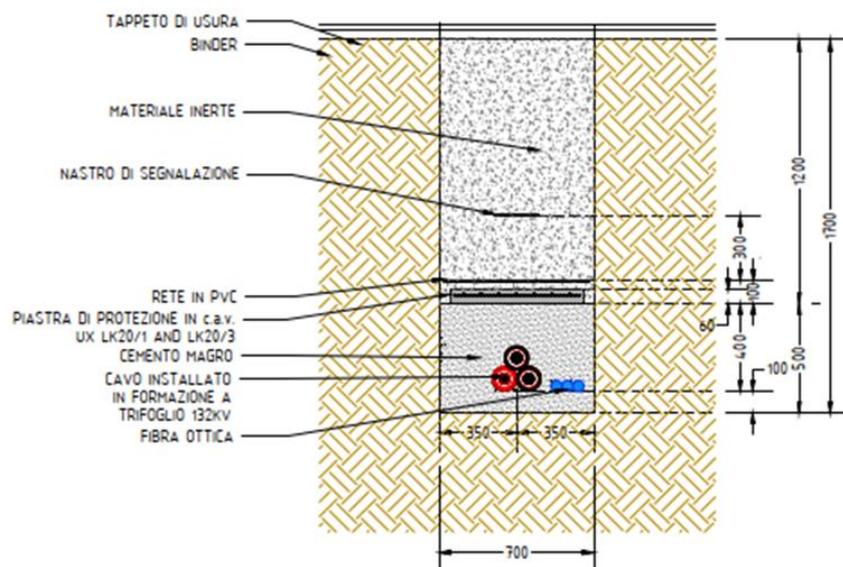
Sezione tipo su strada - Tratto di cavidotto dalla Stazione di Trasformazione alla Stazione di Consegna
